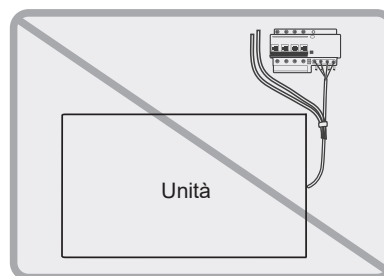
Sistema di controllo e precauzioni di installazione (c)
